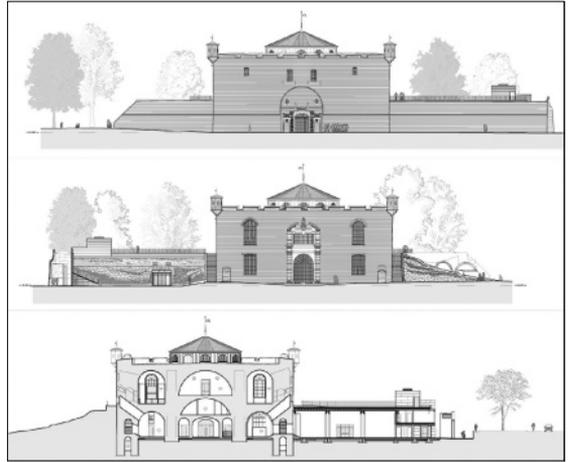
Mastio della Cittadella. Progetto definitivo di restauro e recupero funzionale. Prospetto est e ovest, sezione longitudinale. Città di Torino, Servizio Edilizia per la Cultura, 2008.
